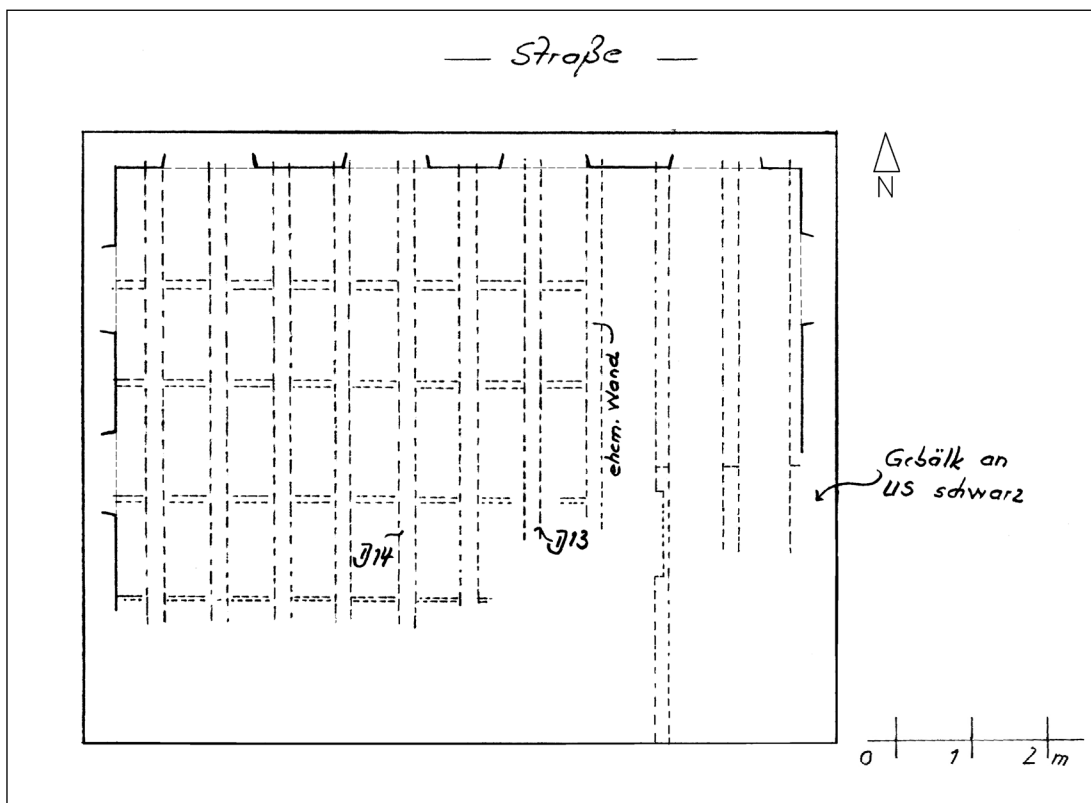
Hauptstraße 65, Grundriss 1. Obergeschoss.
